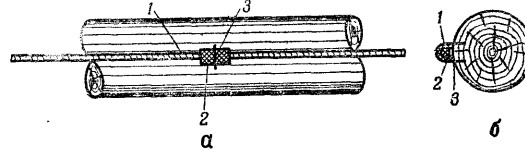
Крепление проводов и детонирующего шнура к элементам деревянных мостов:
